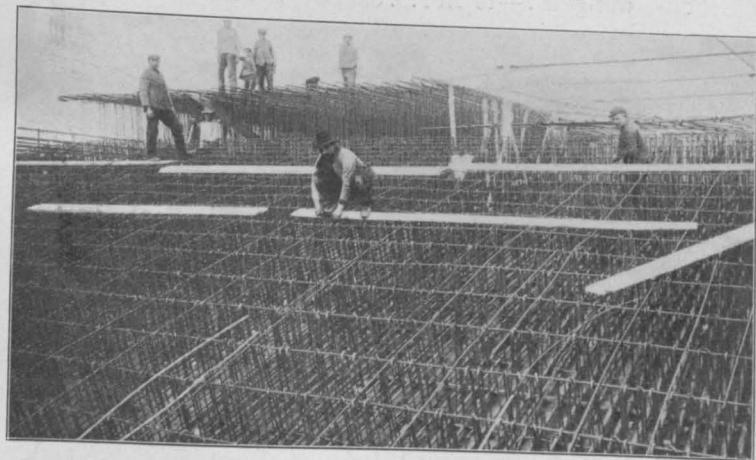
Eisenbewehrung eines Stromgewölbes der Brücke.
